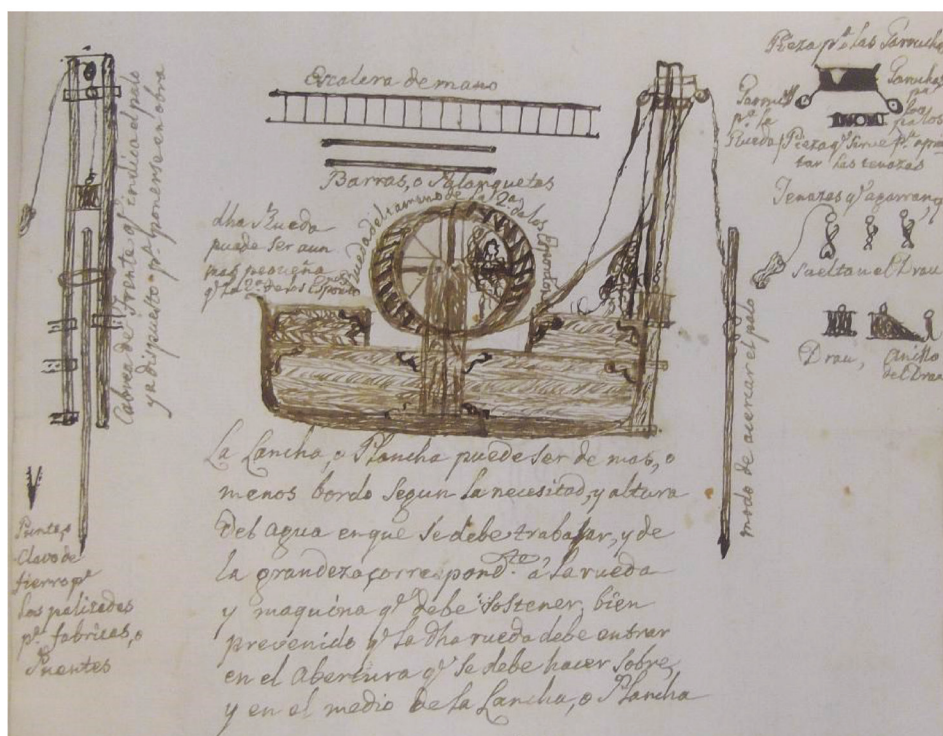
Martinete diseñado en 1787 por el soldado Gaspar Richuti en Ferrol. A.M.N., 529, Ms. 1555/013, f. 21r.
